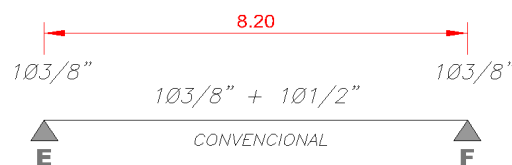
Esquema de las Viguetas Convencionales con su Acero de Refuerzo en los Paños "Q" y "R".
